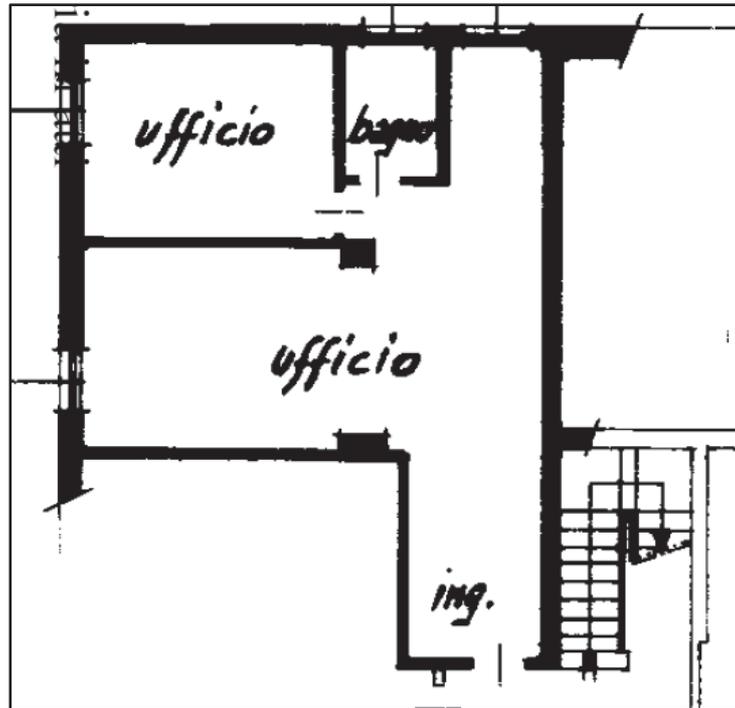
Pianta dell'ufficio (tratta dalla planimetria catastale)
